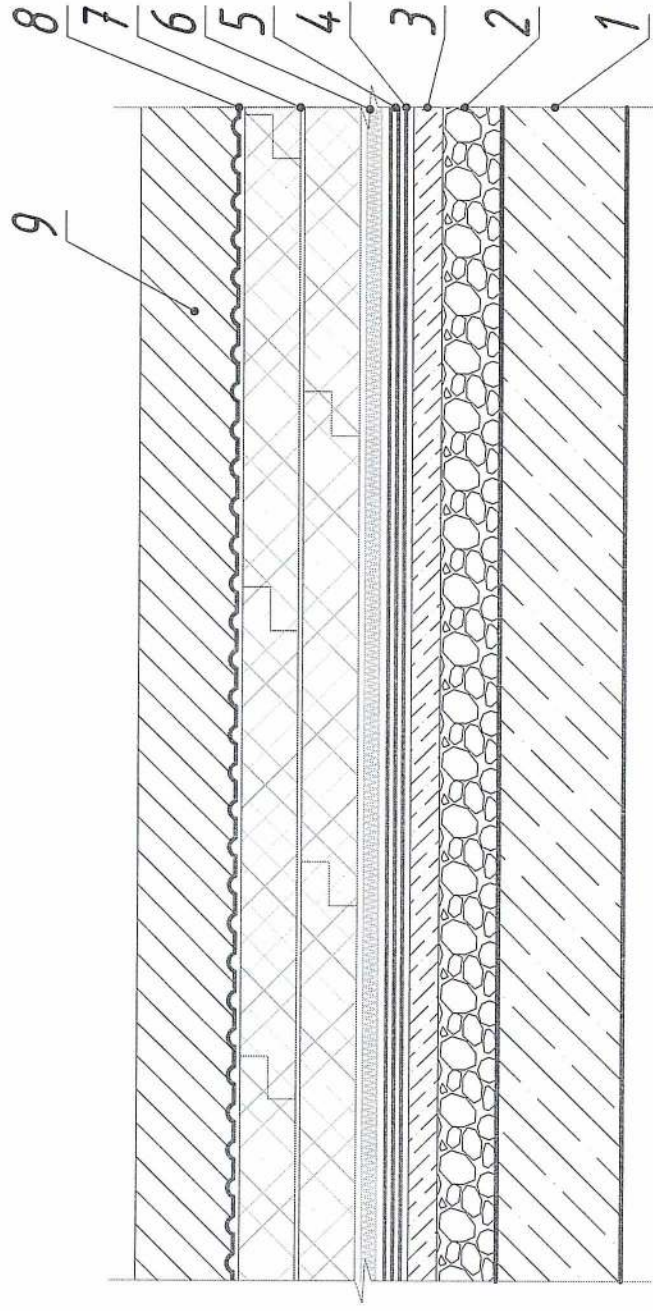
Принципиальная схема конструктивного исполнения бесчердачного покрытия выполняемого по железобетонному основанию (инверсионная эксплуатируемая кровля)
